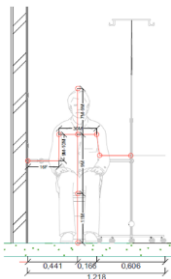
Ruang Gerak Zona Toilet pada Desain
